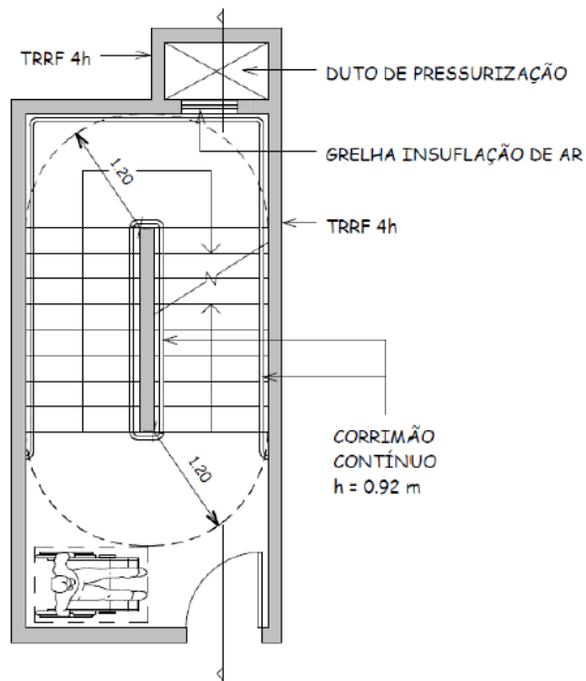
B - Escada à prova de fumaça pressurizada - pavimento intermediário (planta baixa).
